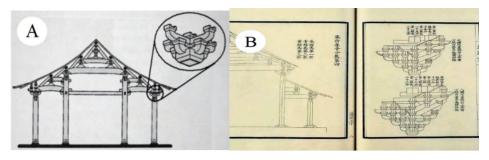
Arquitetura chinesa em madeira. Legenda: A - seção transversal de estrutura em madeira e detalhe de ensambladura. B - Modelo de tratados e manuais para ensambladuras *Yingzao Fashi*, ca. 1100 na China e *Shyomei* ca. 1605 no Japão. Fonte: (HE; et al., 2013)
